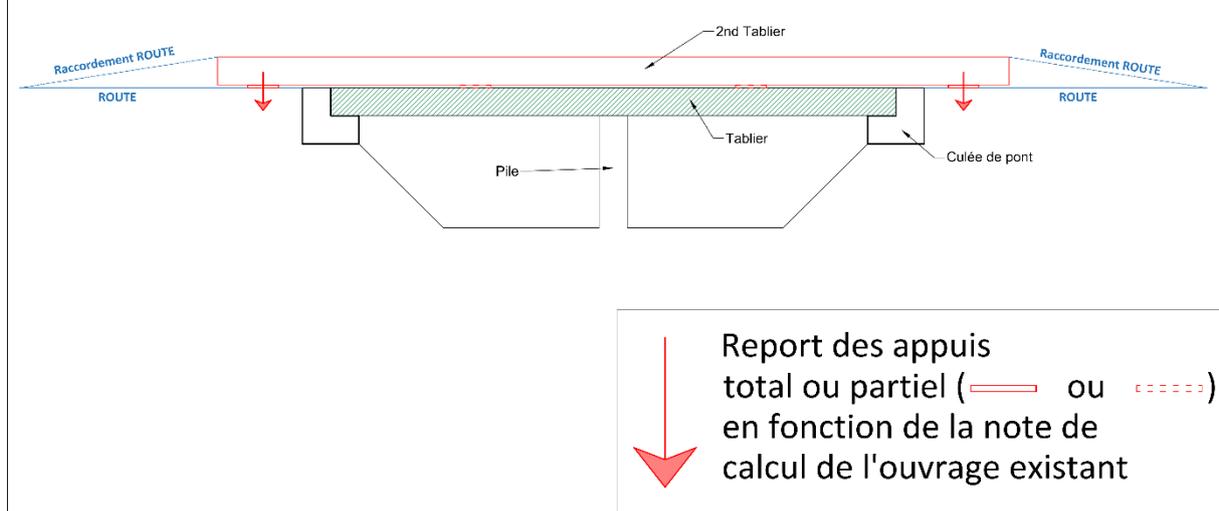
Plan de principe - Ouvrage d'art - Doublage de tablier
